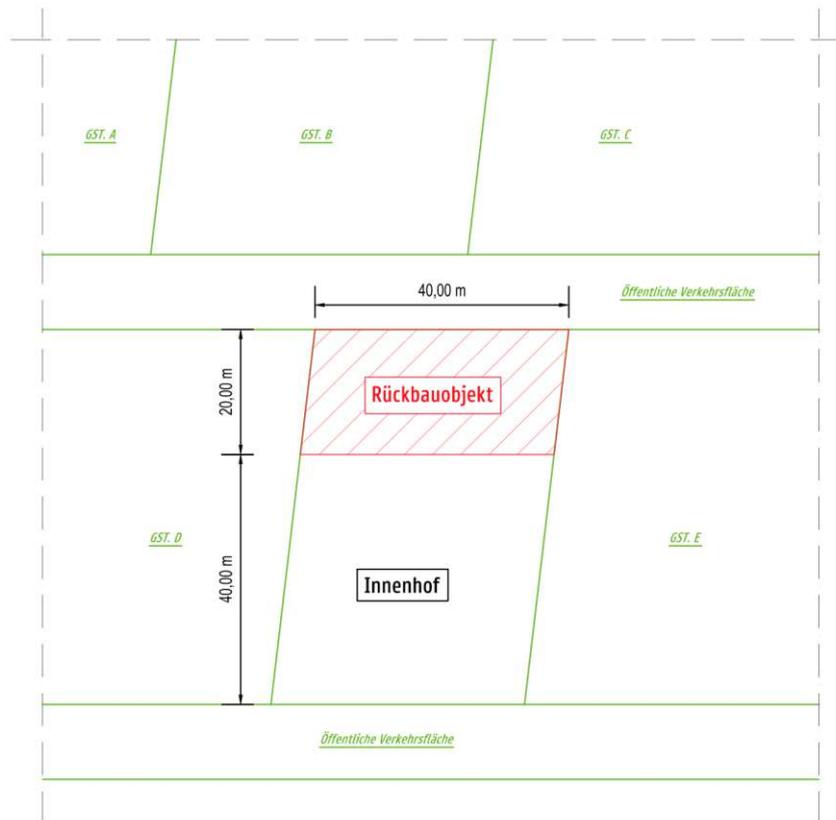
Übersichtslageplan Rückbauobjekt
